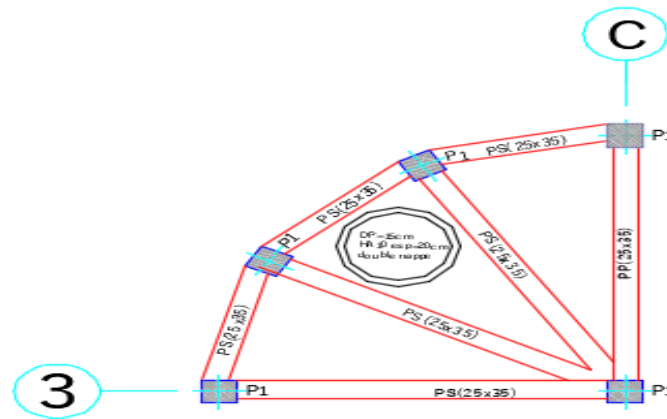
Dalle pleine du balcon repose sur trois appuis
